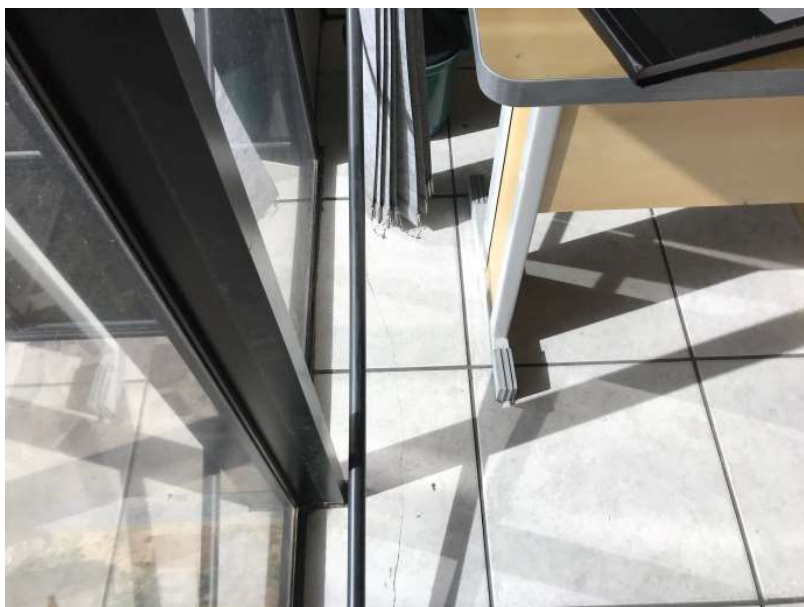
Piso trincado próximo a fachada frontal
